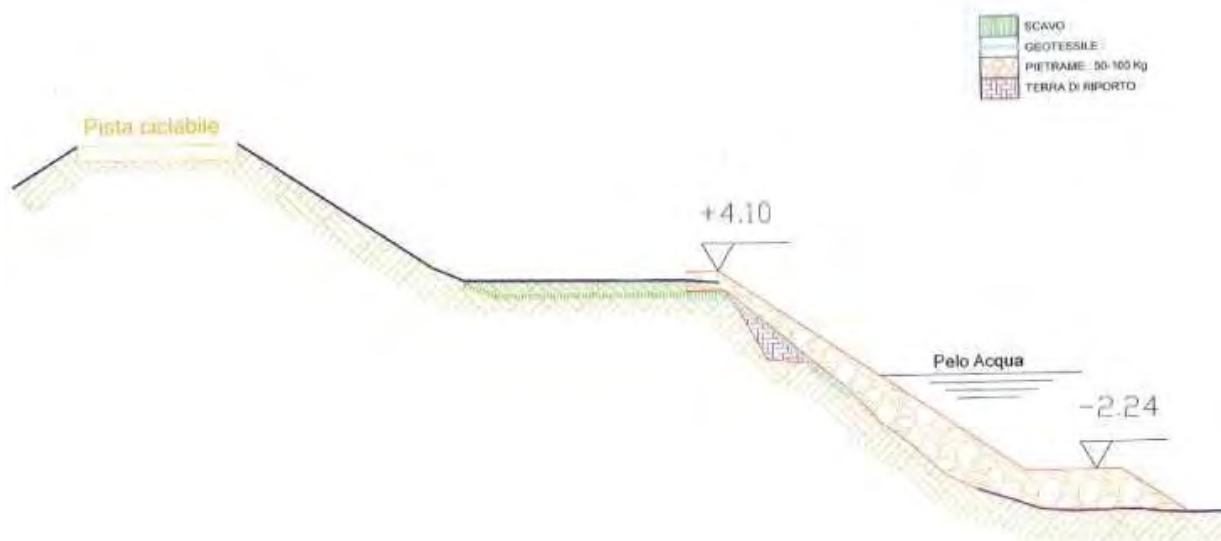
Esempio 4: sezione tipo difesa spondale Po.
